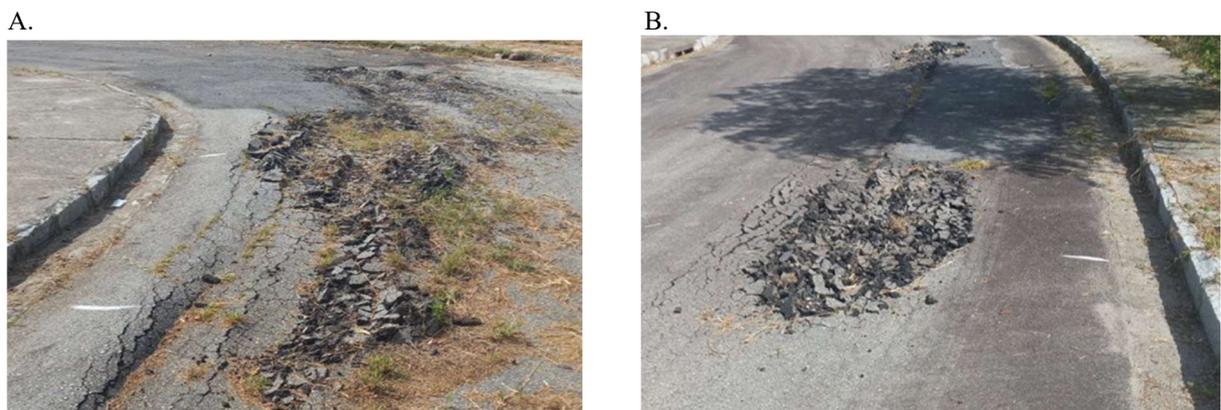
Trincas longitudinais presentes no pavimento do Campus
